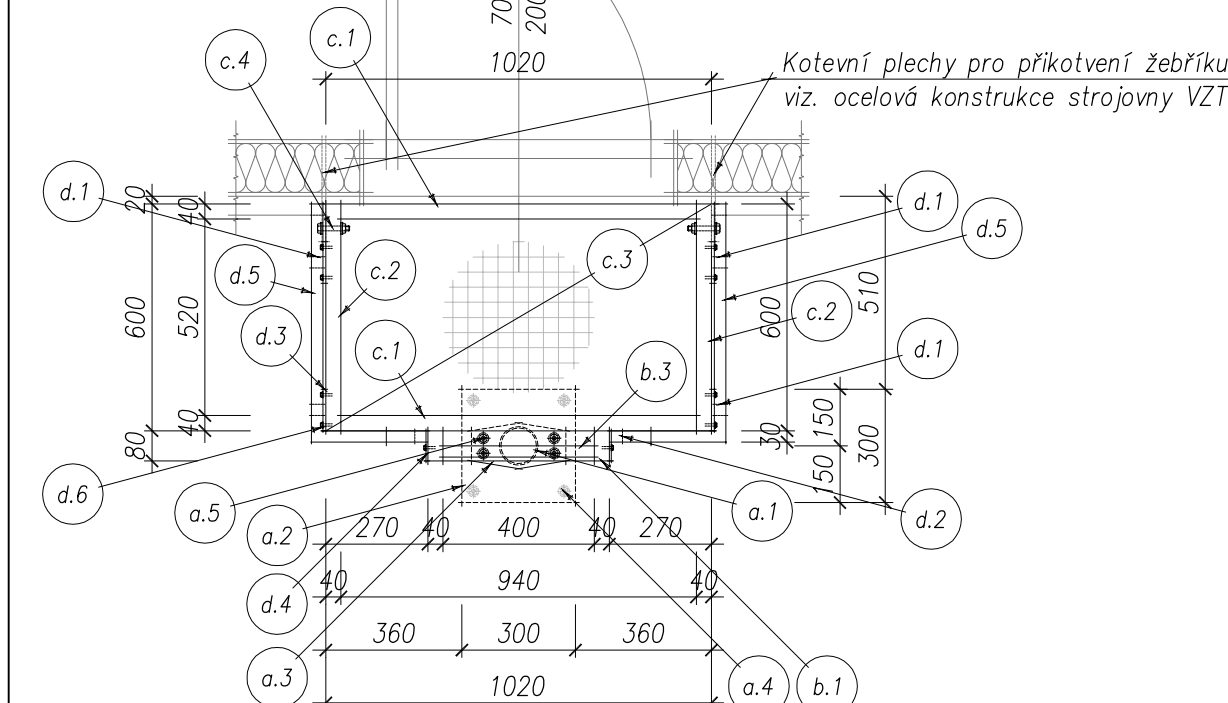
, M 1:20 - PODSTAVA PRO ZVLHČOVAČ
